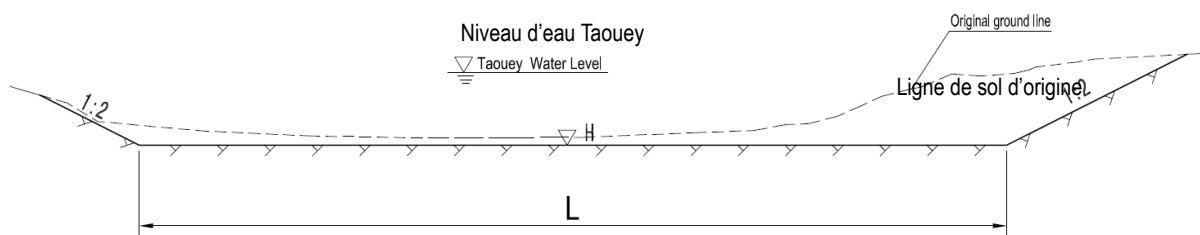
1 Section typique de l'expansion du canal Taouey
